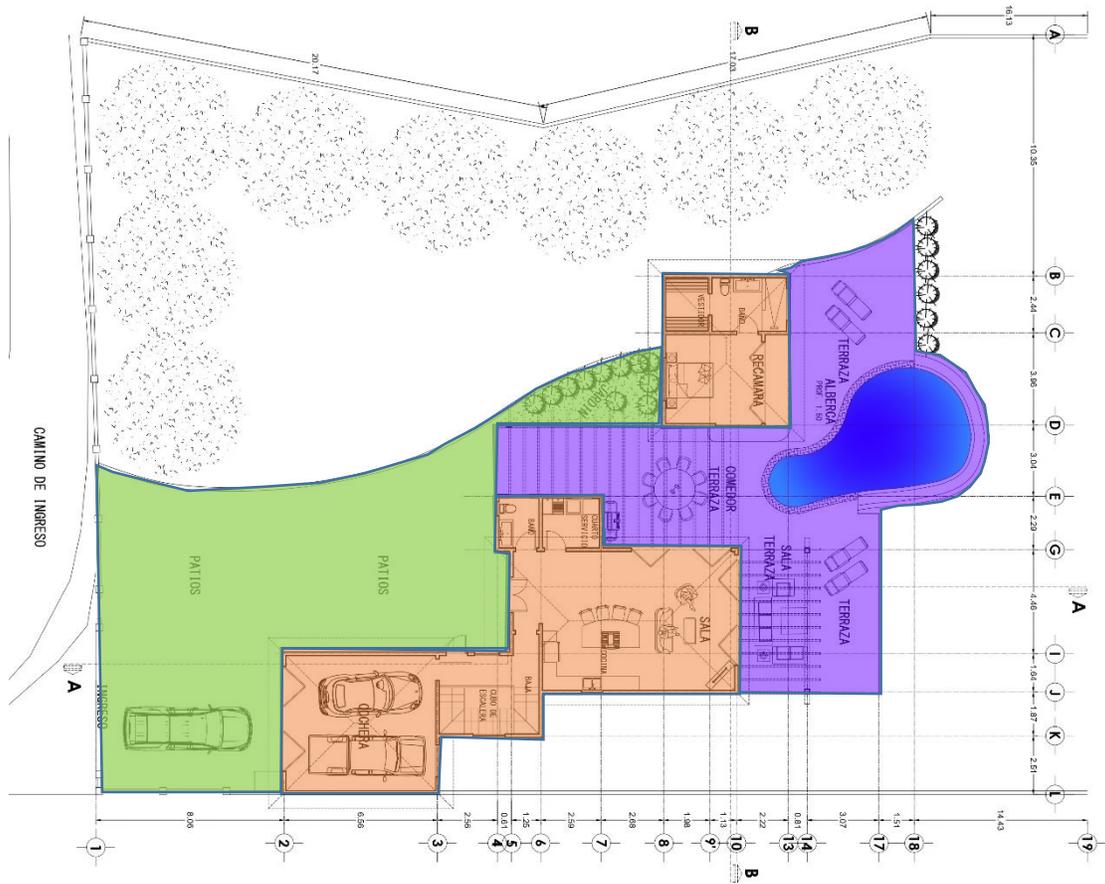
Localización de los espacios arquitectónicos de la planta baja dentro del predio
